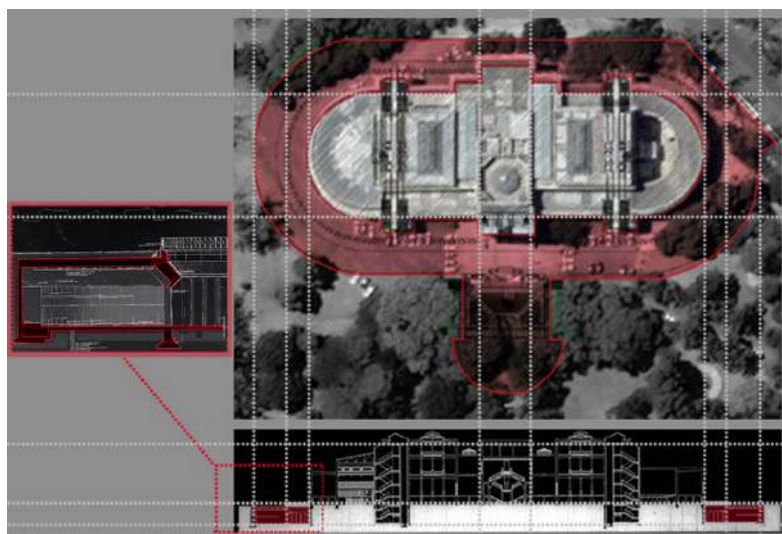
Analisi formale planimetrica del progetto di ampliamento inserito nell'attuale planimetria, sia in pianta che in sezione sono evidenti i rapporti proporzionali tra le parti.
